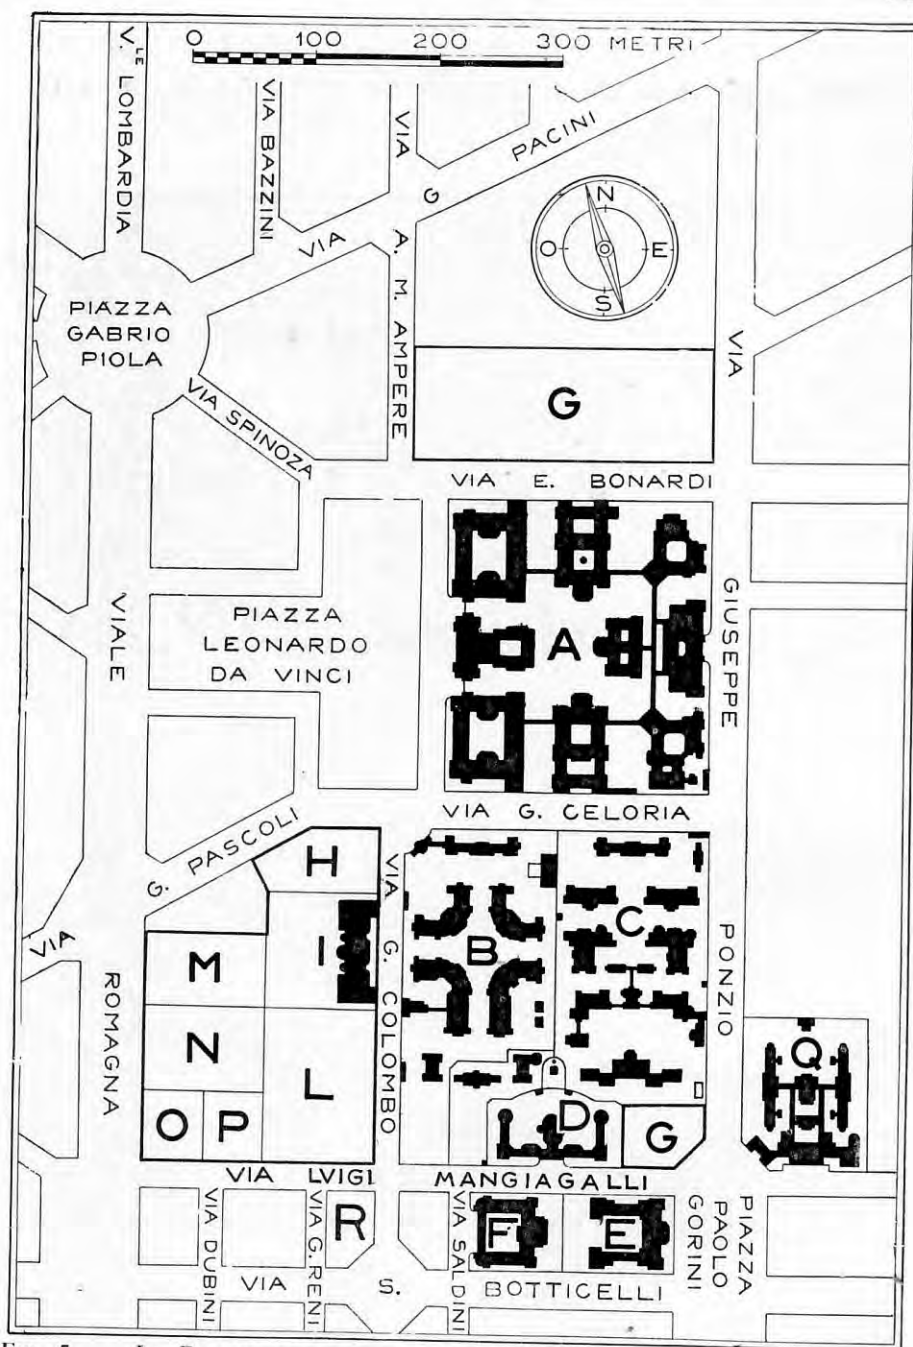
LA PLANIMETRIA GENERALE DELLA CITTÀ DEGLI STUDI NELL'ANNO 1927.
